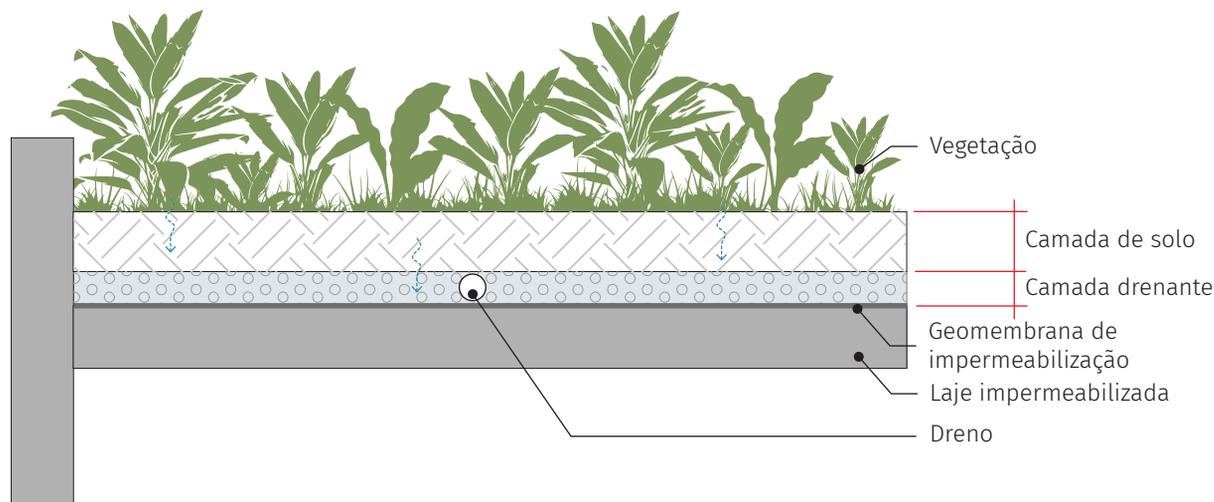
Corte esquemático de telhado verde extensivo (FCTH, 2024)
